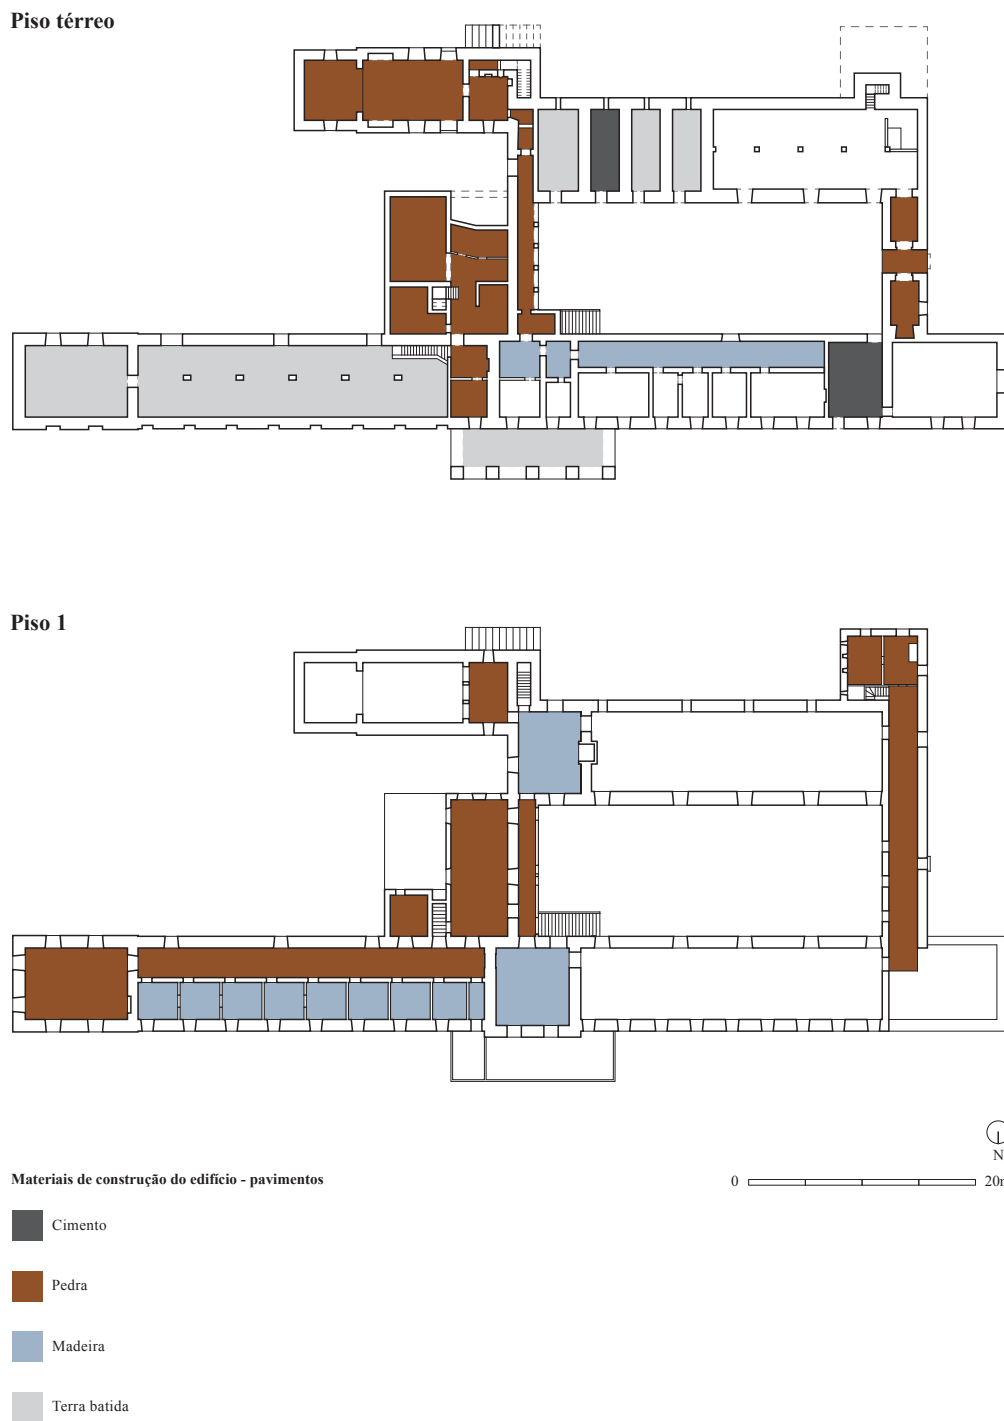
Mapa dos materiais de construção do edifício - pavimentos
